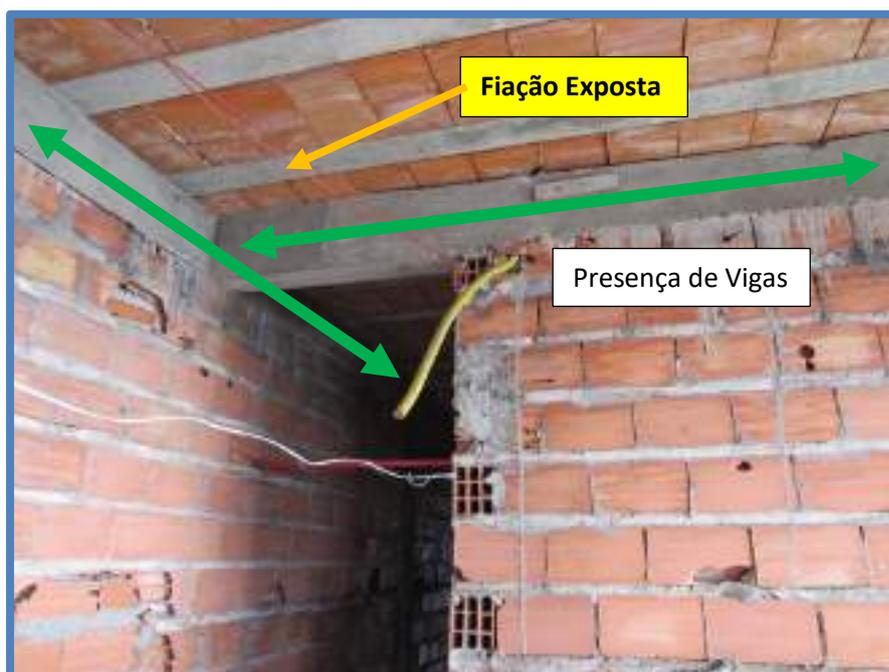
Pavimento Térreo com vigas apoiando a laje.
